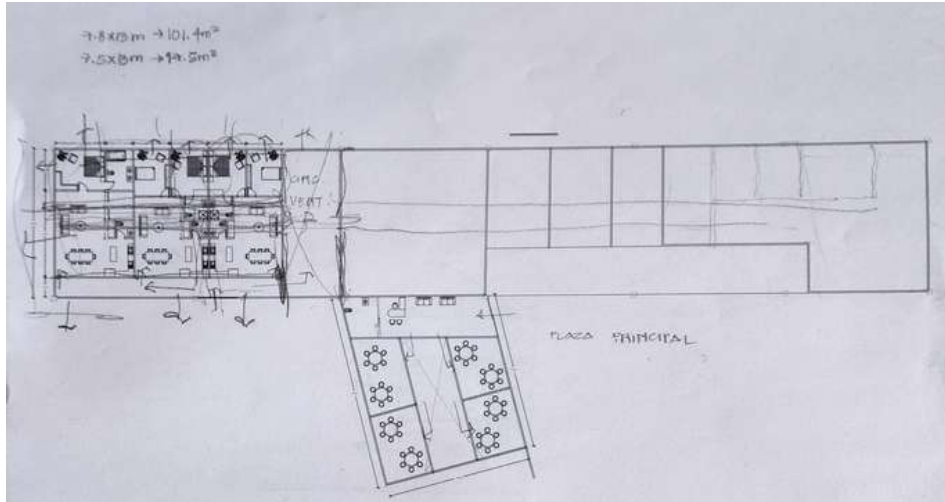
Primera propuesta de diseño. Fuente: Autoría propia.
